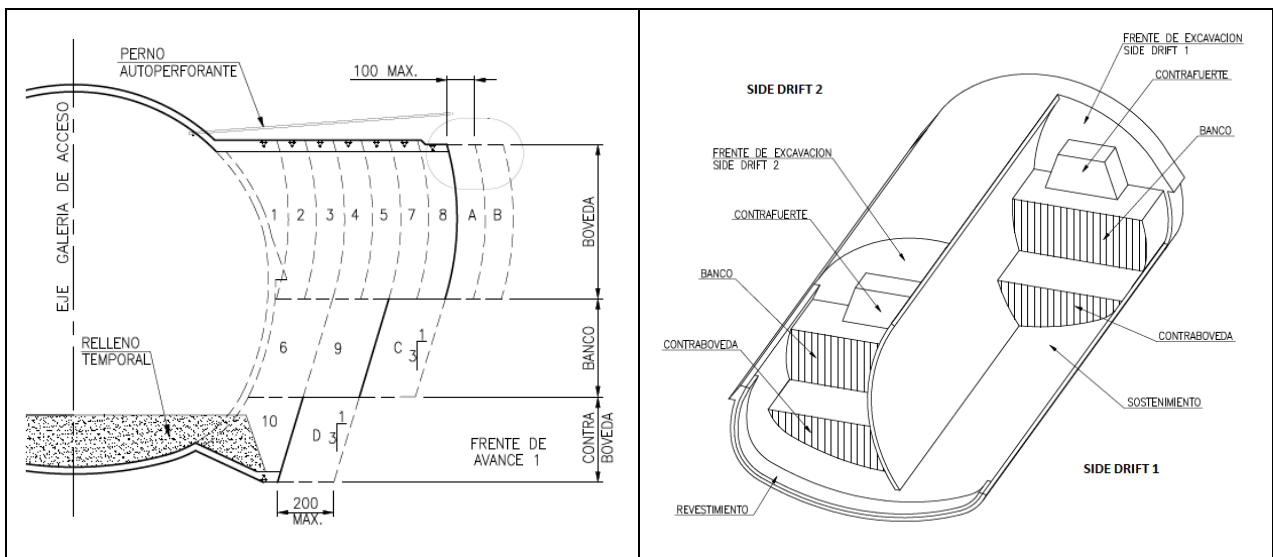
Secuencia de excavación en túnel estación y galería de acceso.
